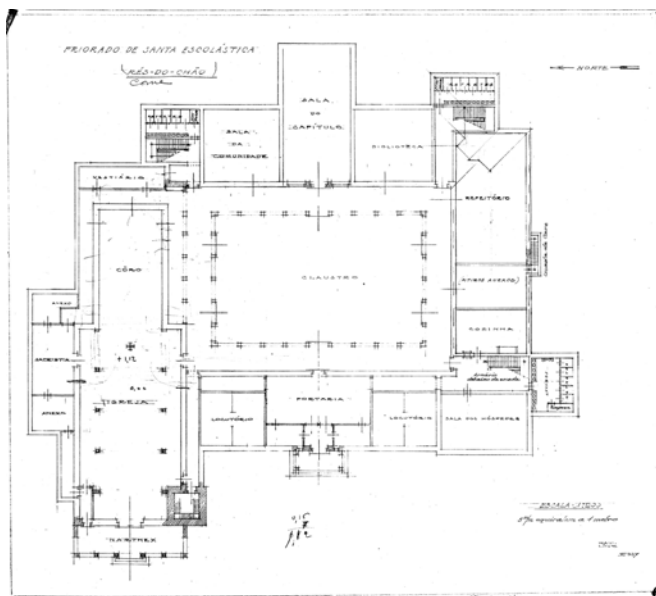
Planta do Anteprojecto do *Priorado de Santa Escolástica*, Fevereiro 1937 (escala original 1:200). 387.17
